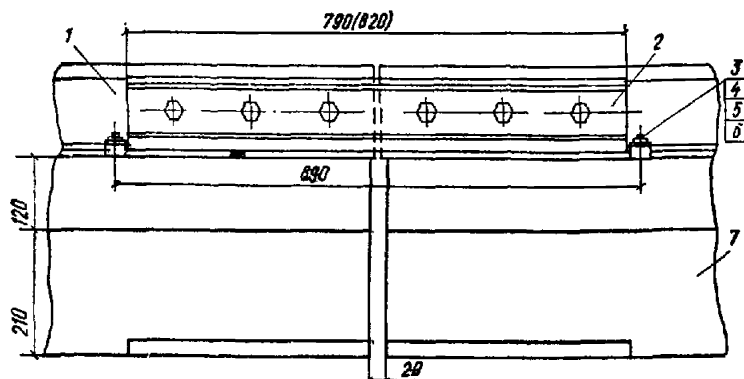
Стык рельсов Р43 (Р50) на железобетонных балках с применением двухголовых накладок
